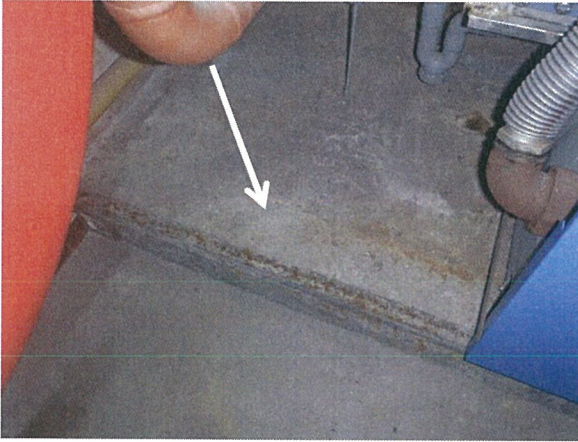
Gebouw AB: ruimtes achter vaste wand-, plafond- en vloerdelen geen onderzoek uitgevoerd.
